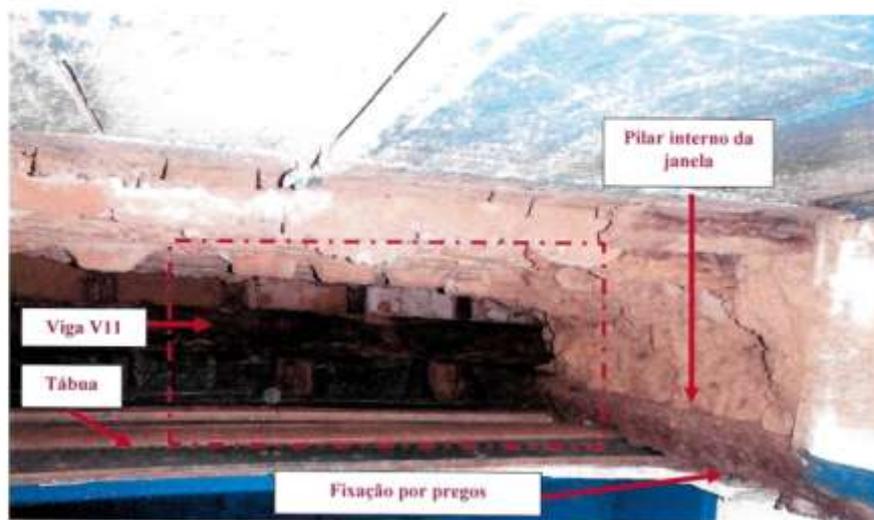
Fixação da tábua aos pilares internos da janela (Vista inferior).
